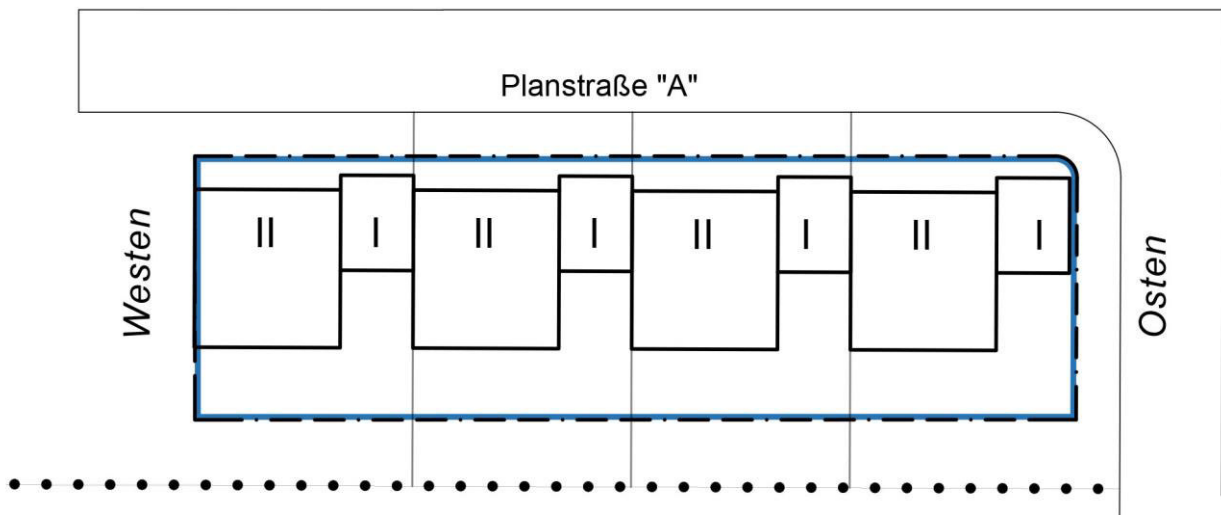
Kettenhausbauweise, Grundriss (Beispiel)
